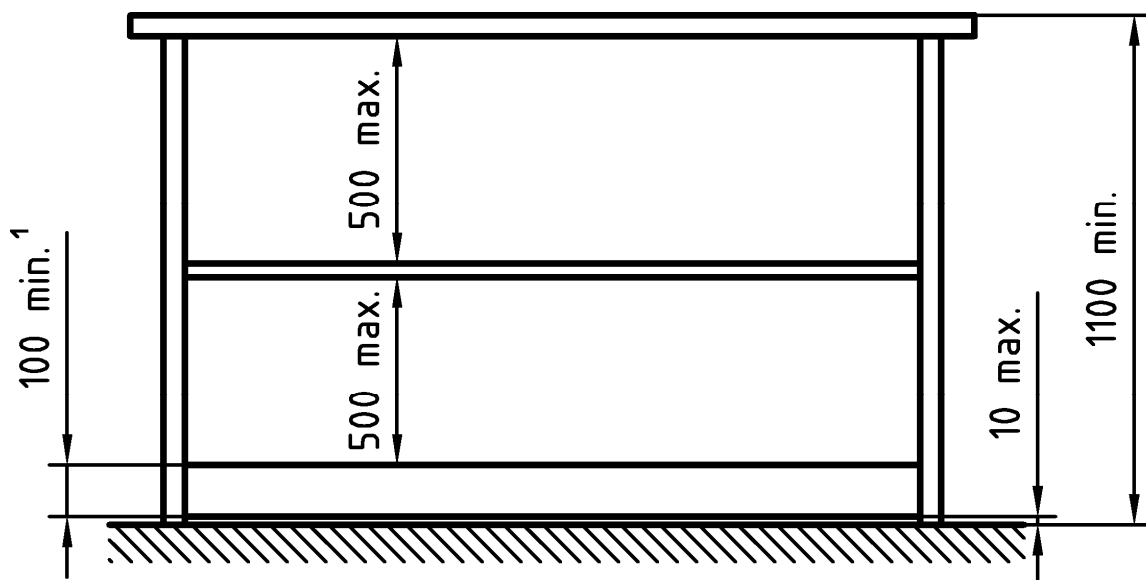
Exemple de garde-corps horizontal (cotes en mm)
